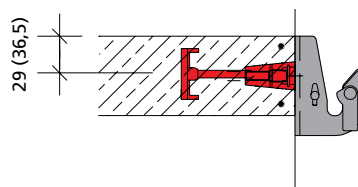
Point d'ancrage en rive de dalle non soutenue
